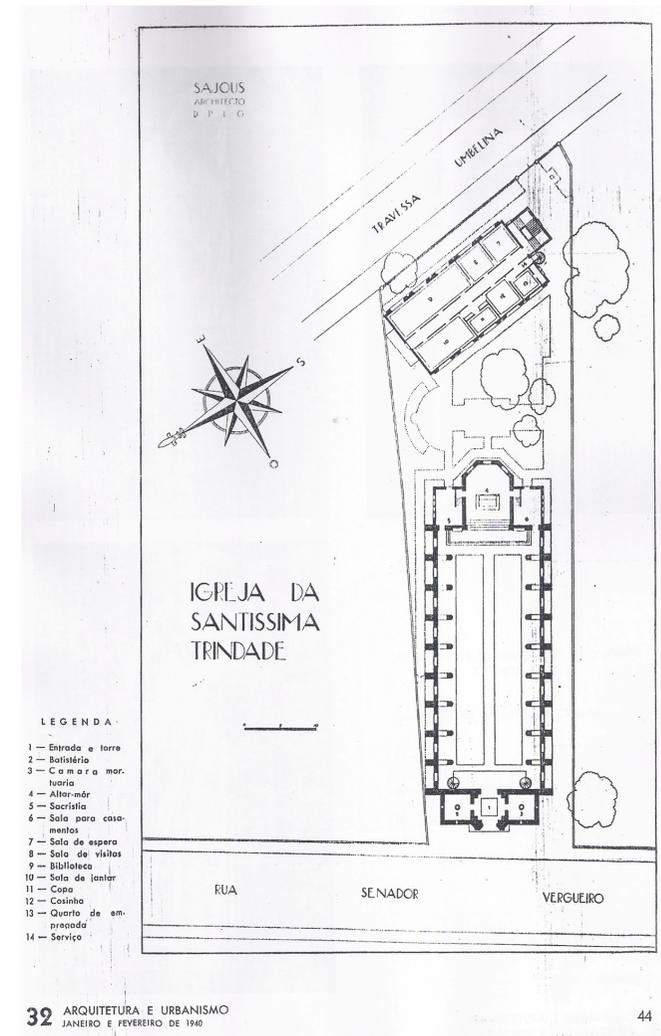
Planta da Igreja e da Casa Paroquial da Santíssima Trindade, bairro do Flamengo - Rio de Janeiro.
